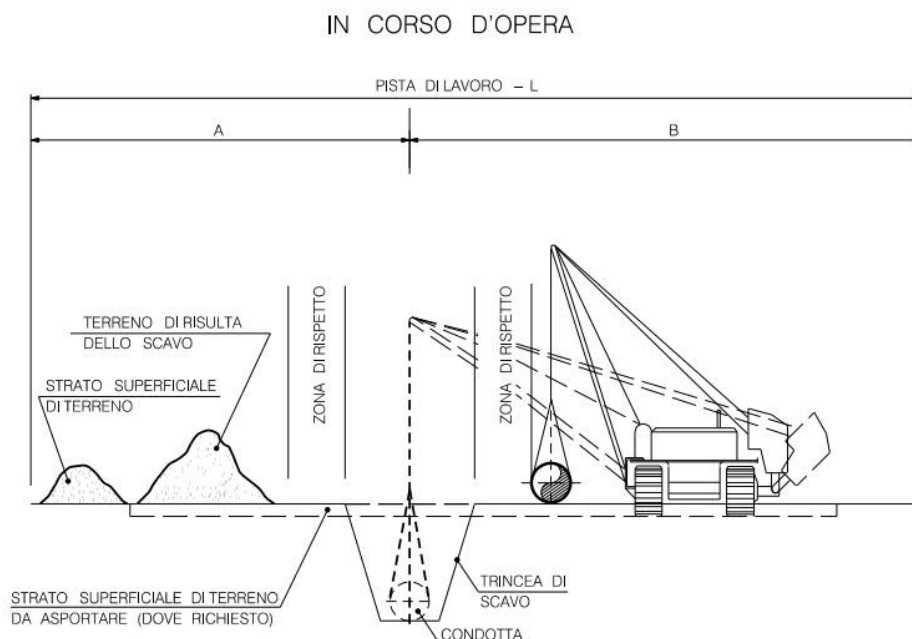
A: Sezione standard della Pista di Lavoro
